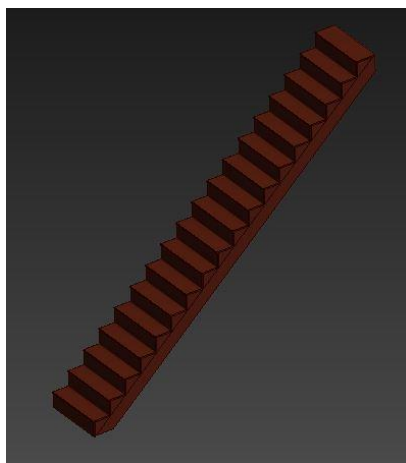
Vista del conjunto de vigas y escalones clonados.
